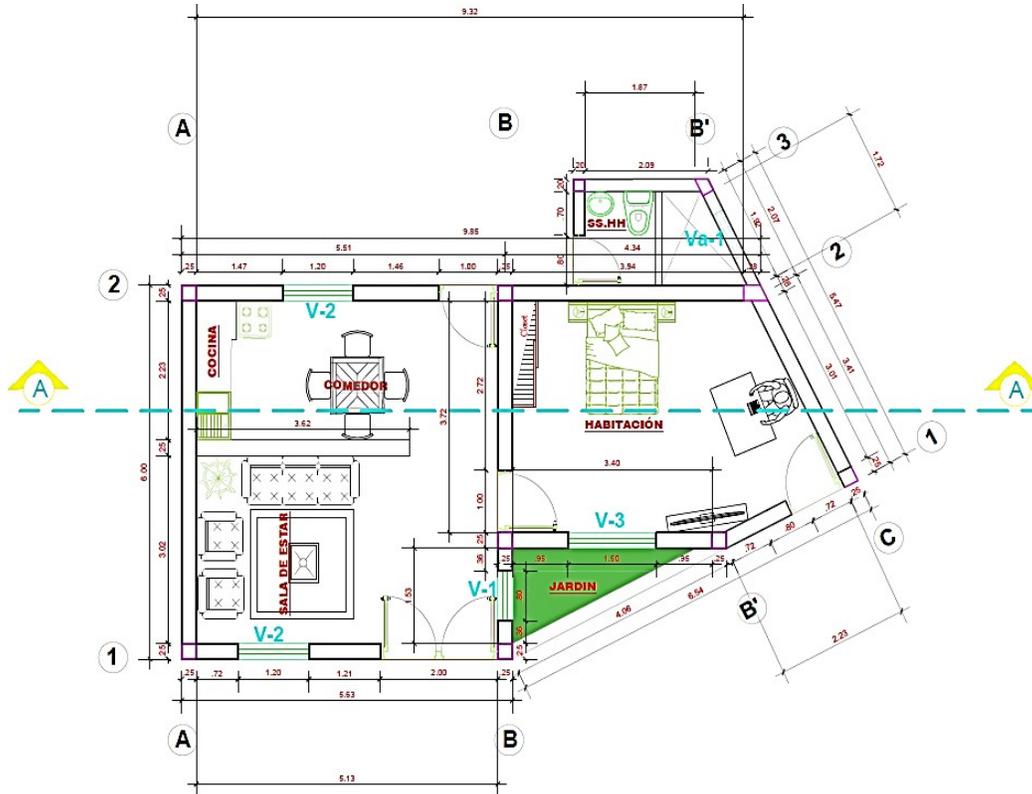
Vista en planta de la distribución del módulo de vivienda ecológica
